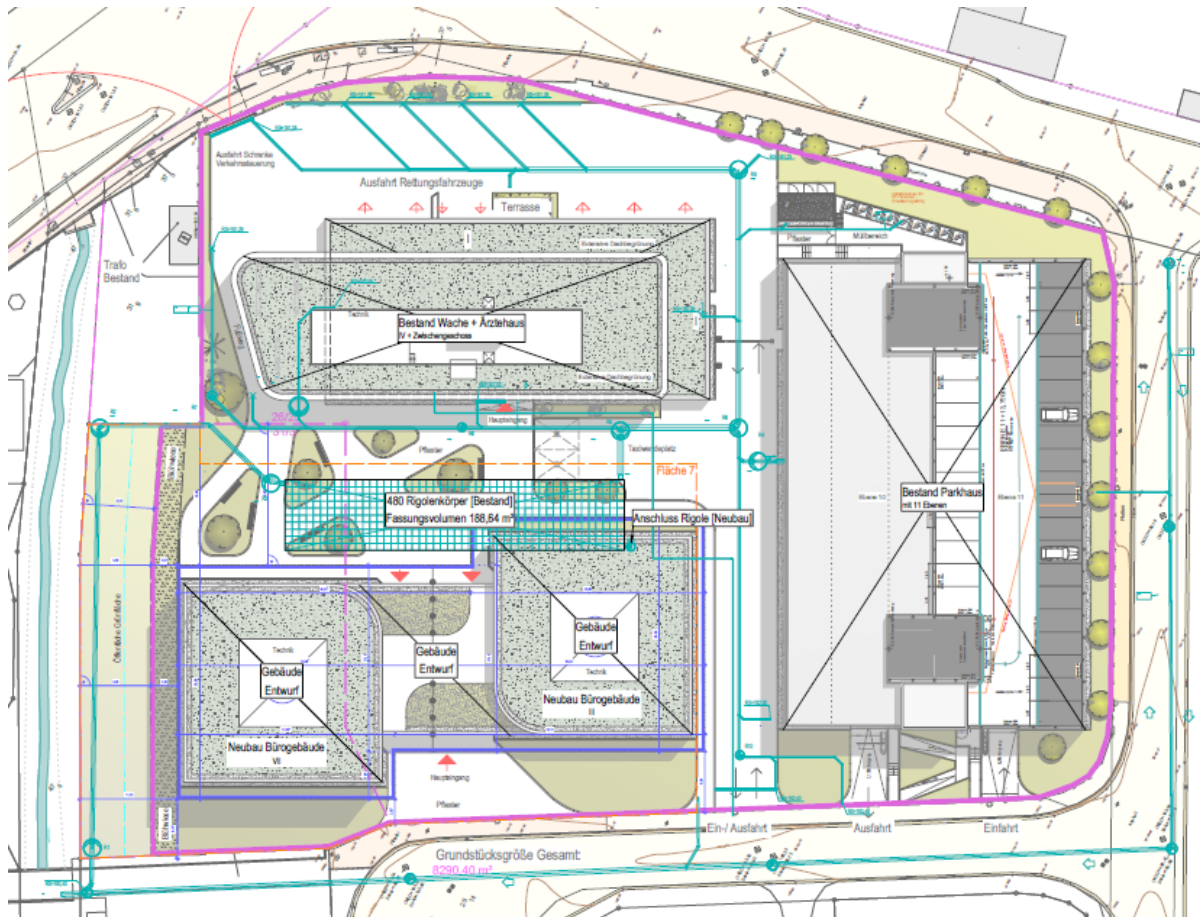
Entwässerungsplan Volksbank Mittelhessen e.G. – Planung im Endausbau
